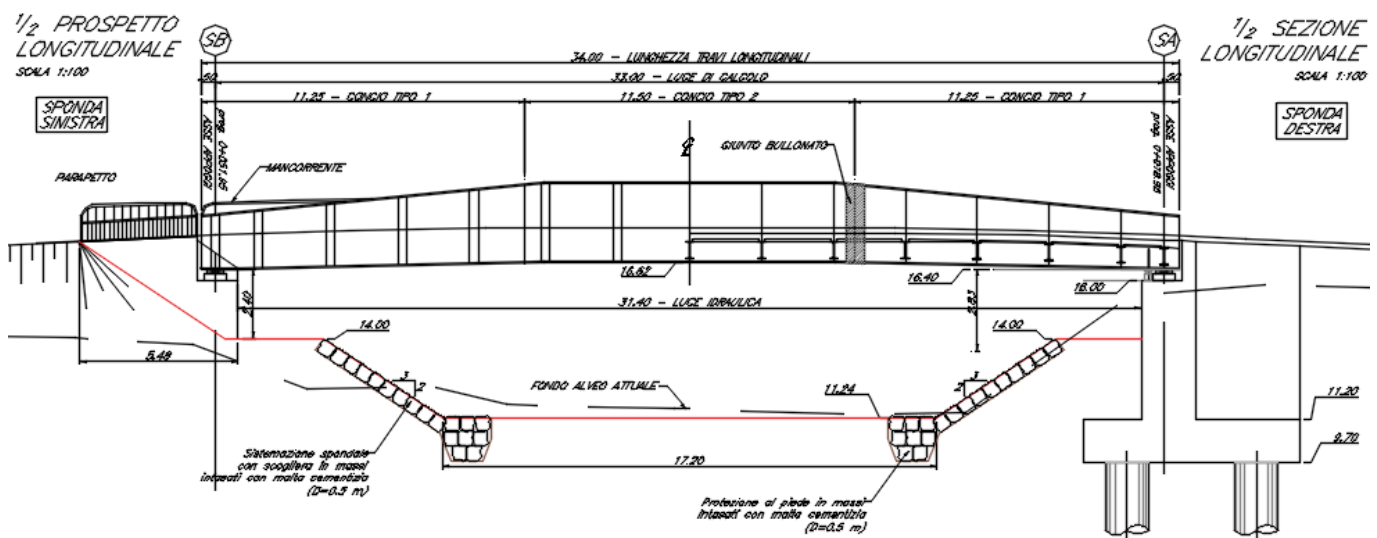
Nuovo Ponte stradale sul torrente Evigno – San Pietro, sezione a monte del viadotto.
